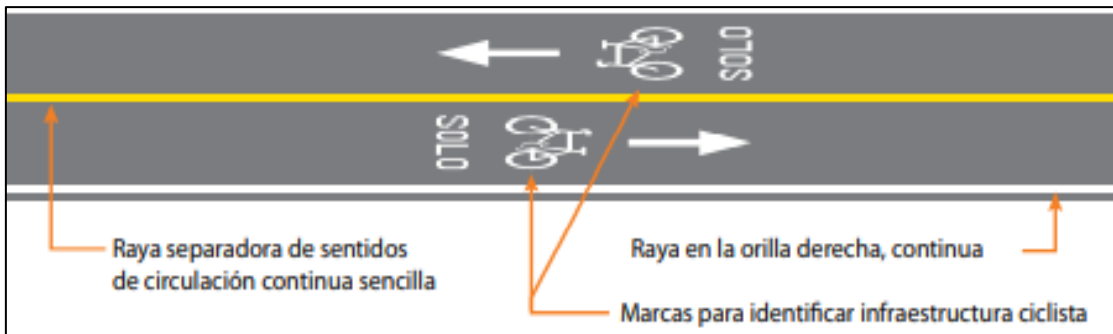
Calzada de ciclovía en tramo donde se encuentra prohibido el rebase
